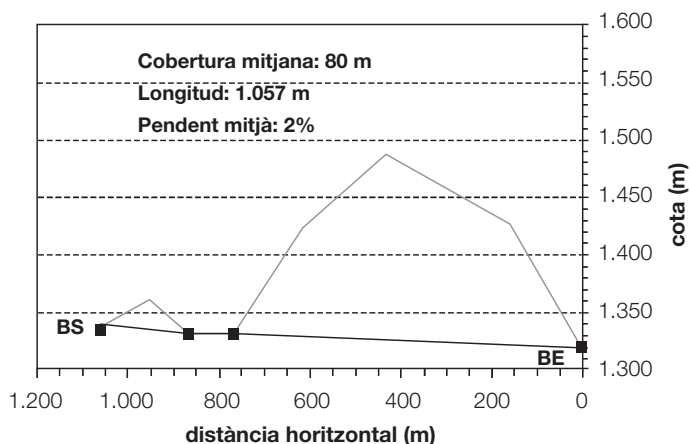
Perfil longitudinal del túnel del Cargol amb la posició de la boca d'entrada i la de sortida juntament amb el tram exterior de 150 m.
